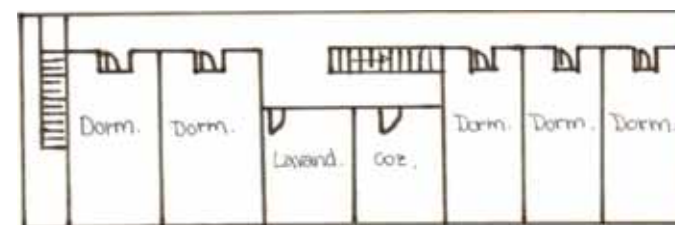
Planta do segundo e terceiro pavimento do alojamento Pedro Nunes. Fonte: FERRO, 2010.
